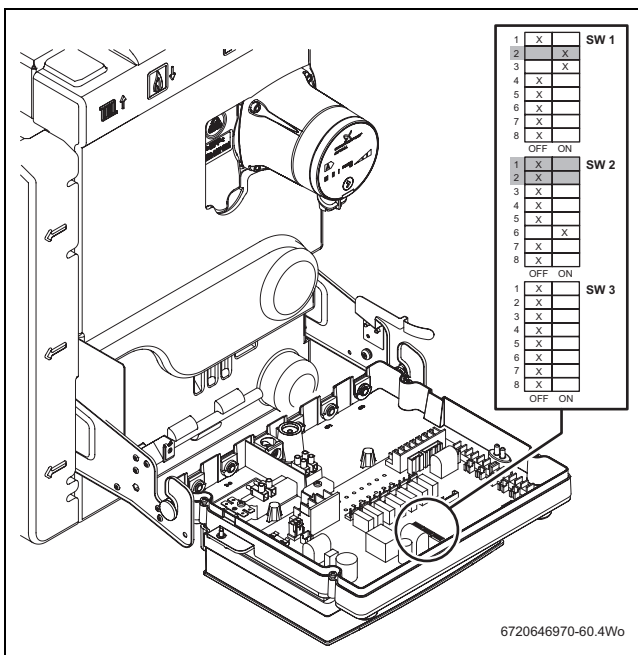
DIP-Schalter in der Position „Kältemittel zurücksaugen“
